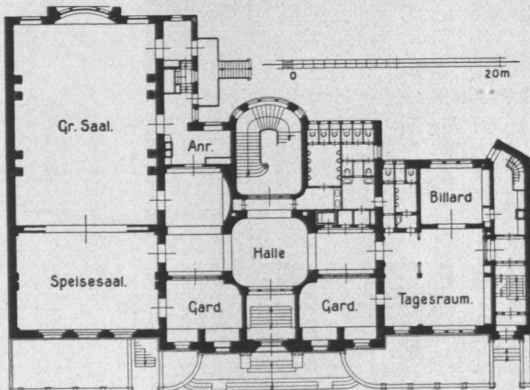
Provinzialloge von Niedersachsen, Erdgeschoss, Grundriß.
